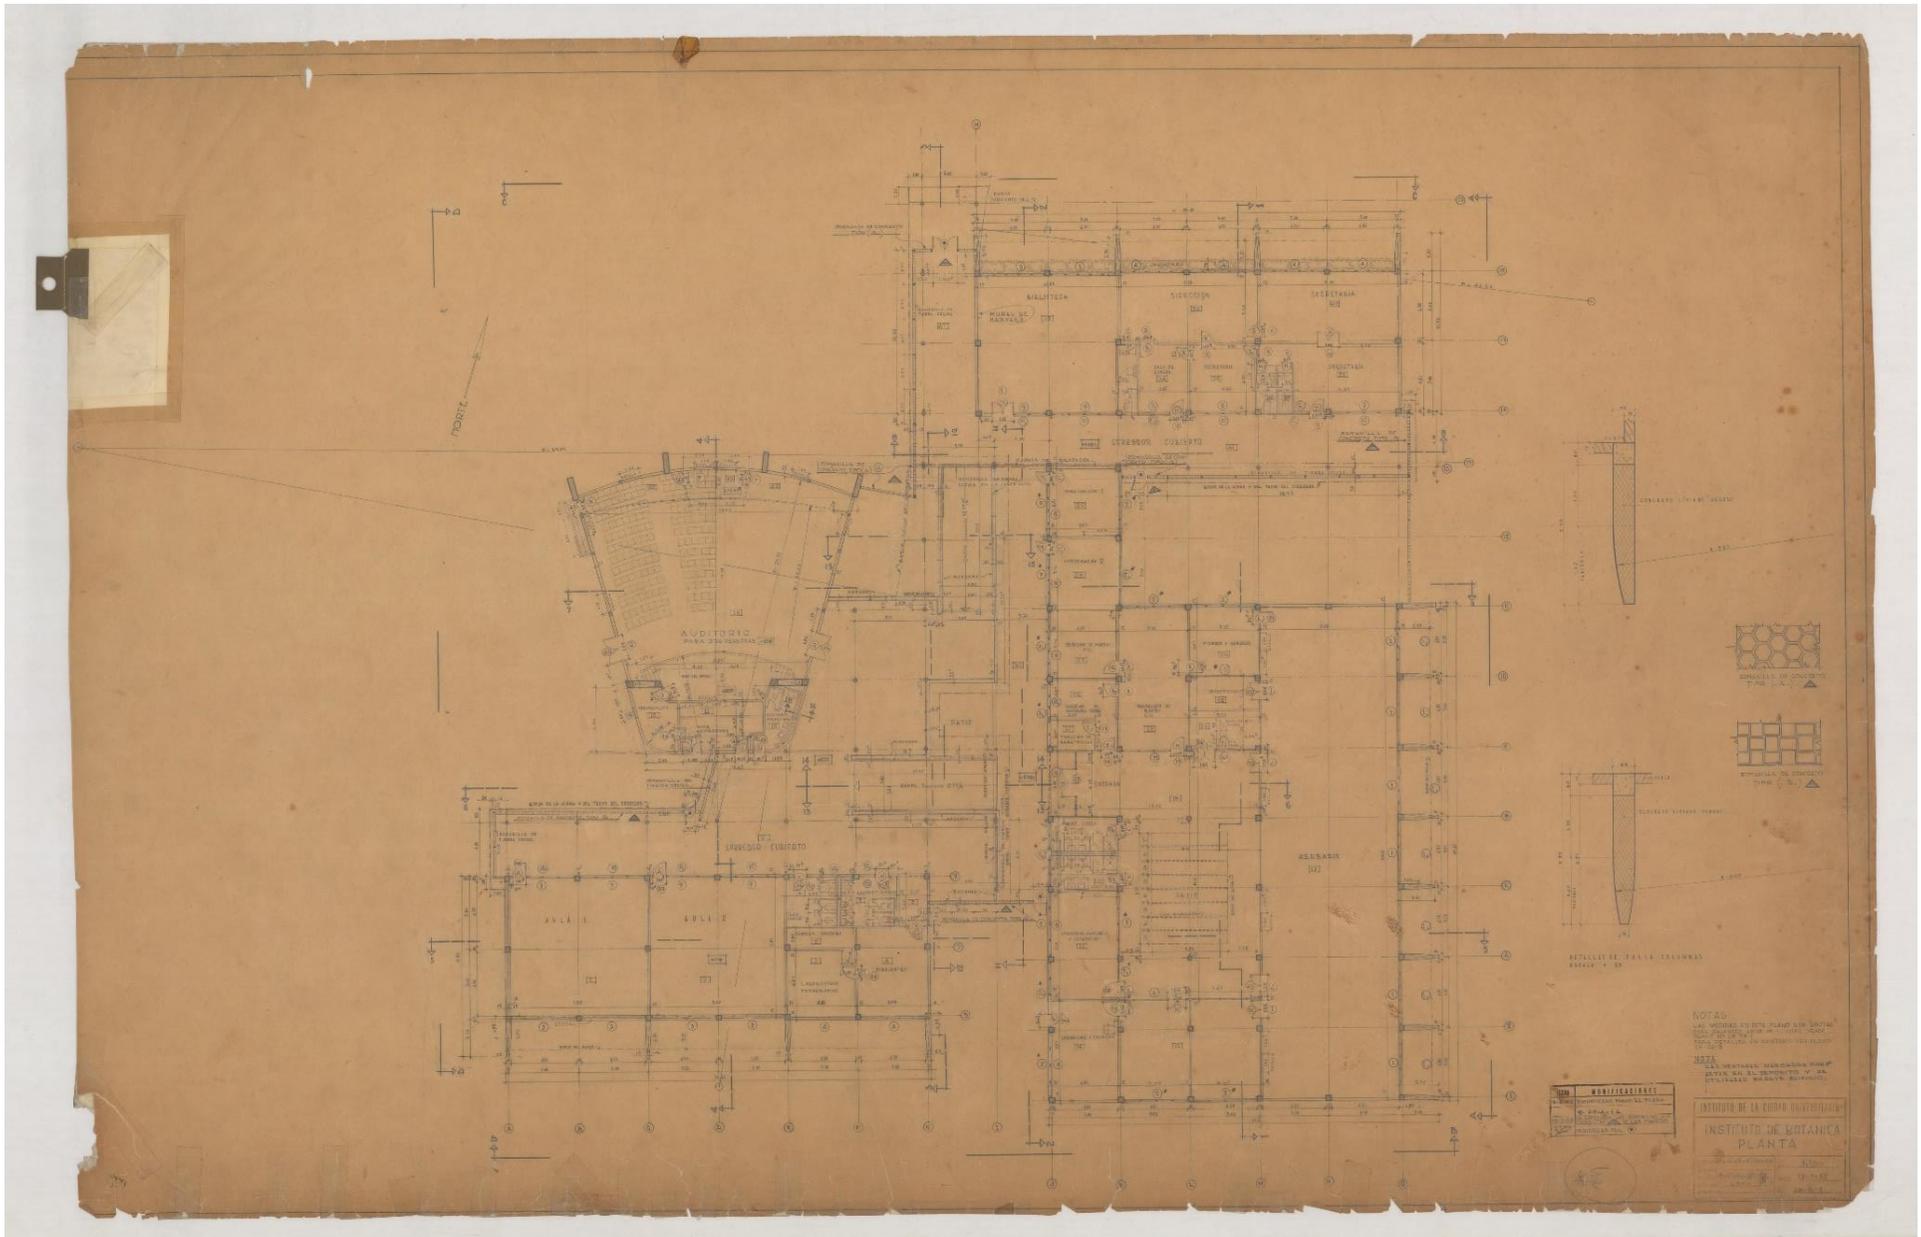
Planta del Instituto Dr. Tobbias Lásser de 1952
